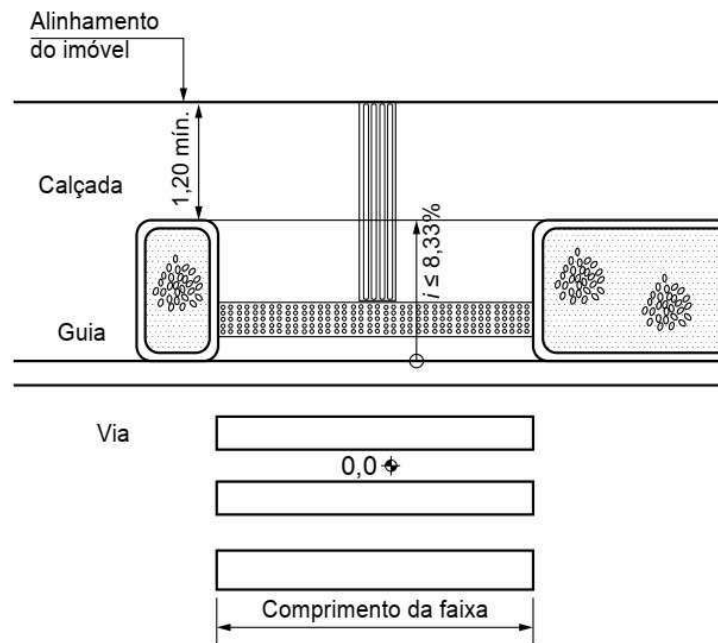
Rebaixamentos de calçada entre canteiros – Vista superior
